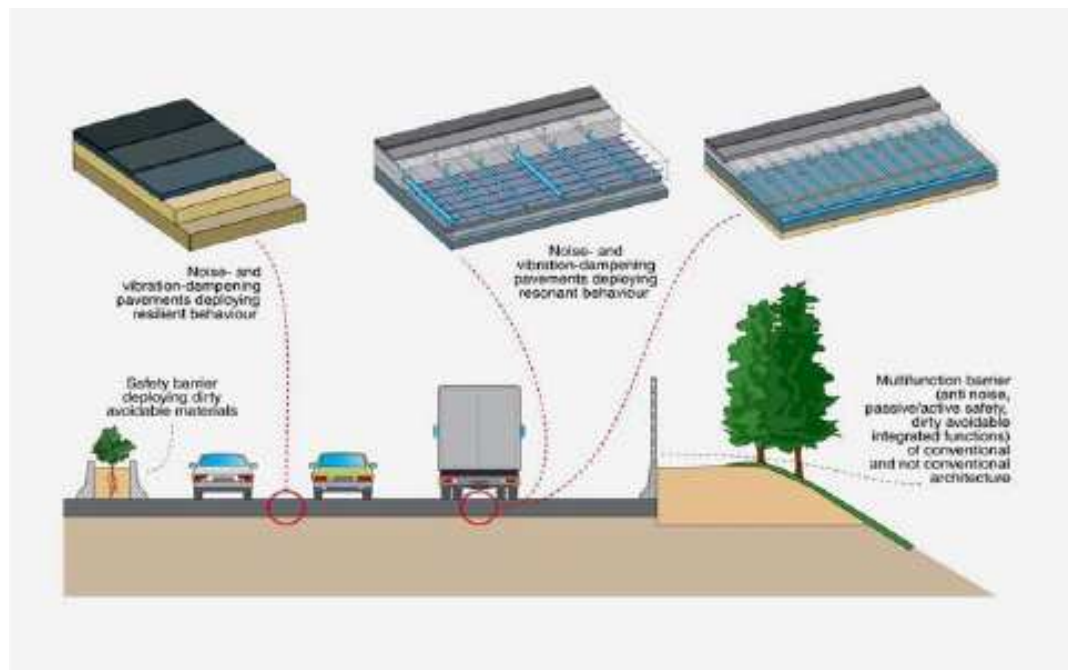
Beberapa material inovatif konstruksi jalan
